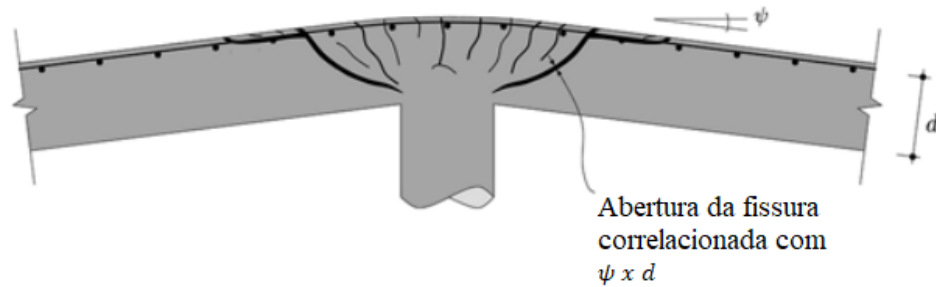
Correlação entre a abertura da fissura crítica de cisalhamento, espessura da laje e a rotação ψ (Adaptado de MUTTONI, 2008)
